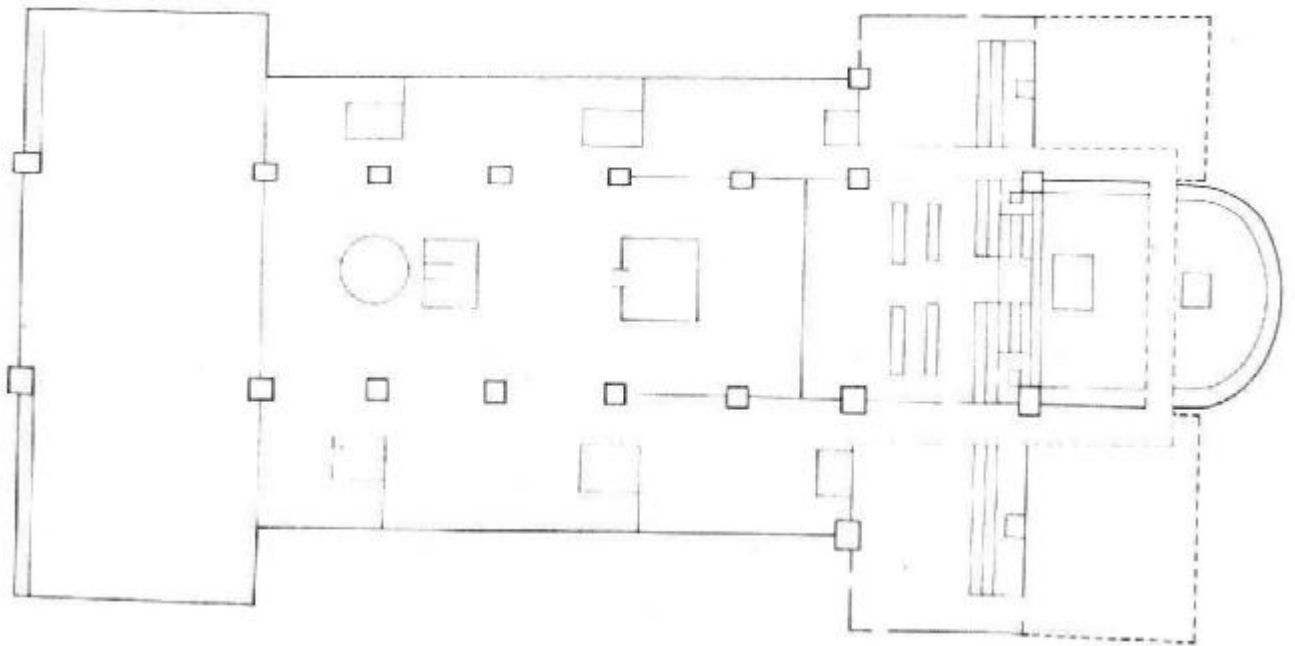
St. Galler Plan, erste Fassung nach Jacobsen
